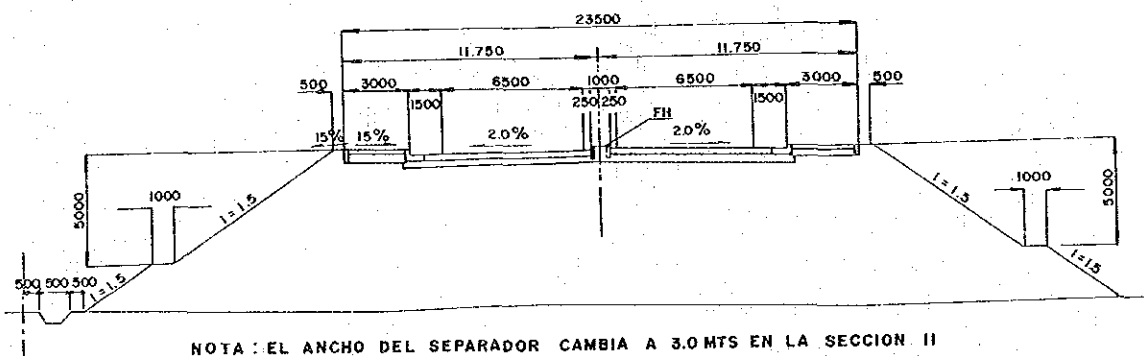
SECCION DE CONSTRUCCION DE LA AVENIDA DEL RIO
